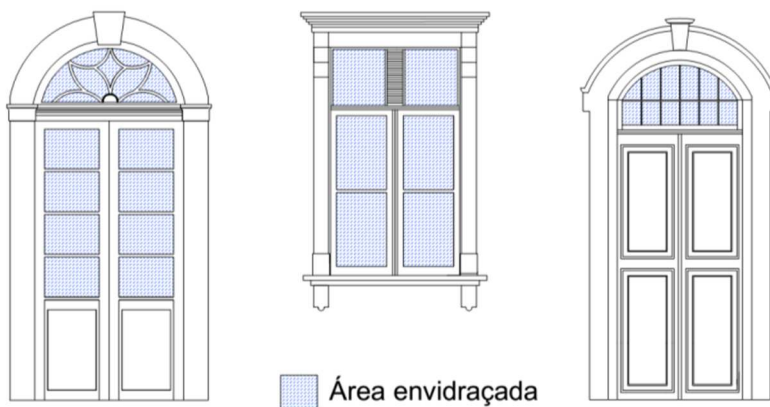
Consideração das áreas envidraçadas para o cálculo do percentual de área de janela por fachada
